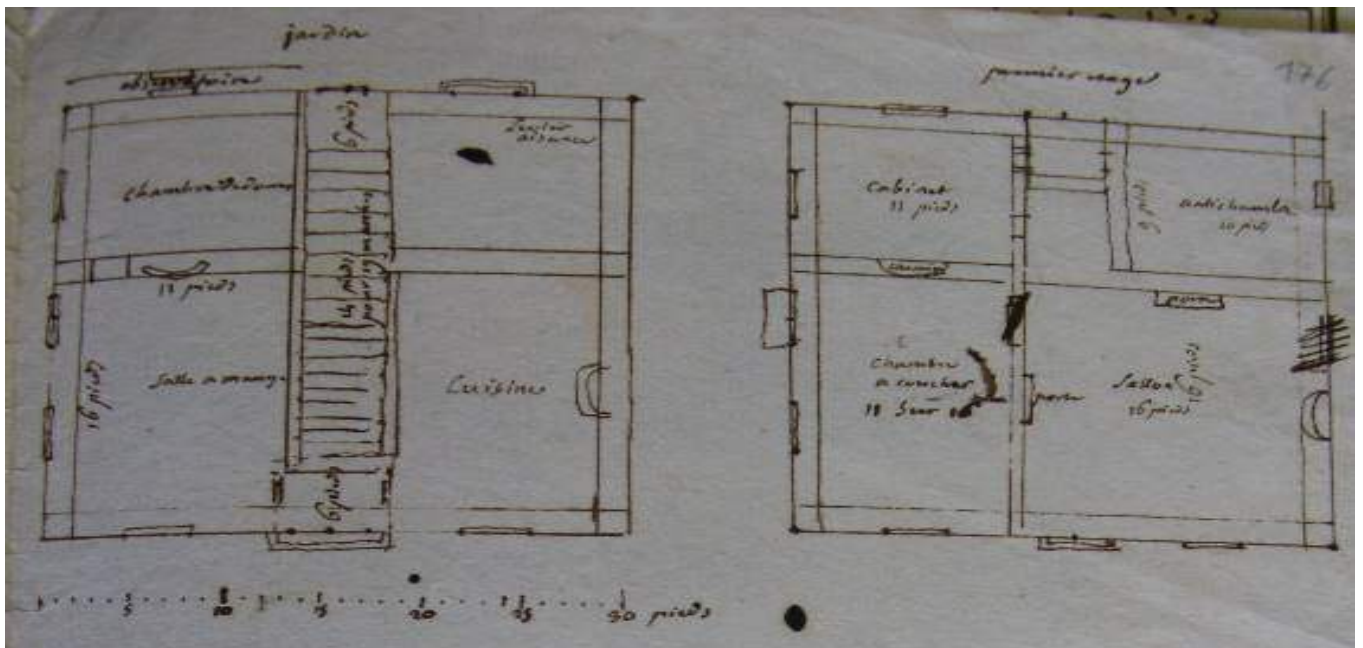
Plan du rez de chaussée et du premier étage de son observatoire à Bourg de la main de J. Lalande, non daté . Carpentras, Bibliothèque-musée Inguimbertaine, Archives Raspail, Dossier Lalande, Ms 2762 Fol 176.
